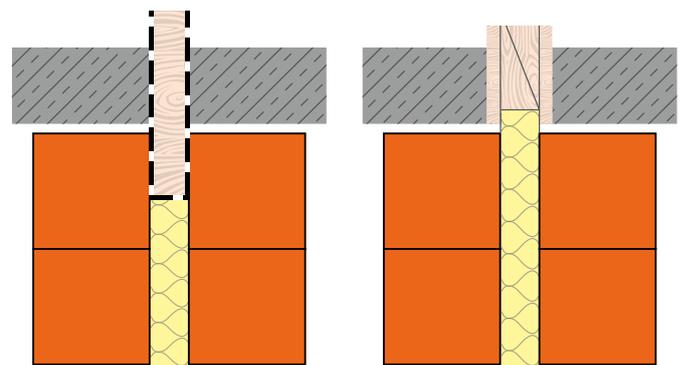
Maßnahmen zur Reduzierung des Auftretens von Körperschallbrücken im Bereich der Geschosdecken bei der Errichtung zweischaliger Haustrennwände
